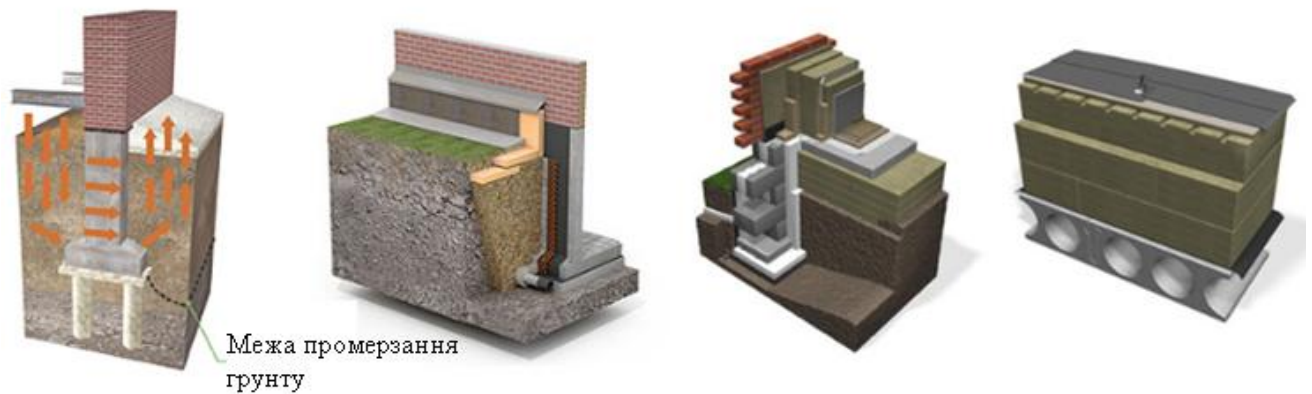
Облаштування та теплоізоляція фундаменту будинку
